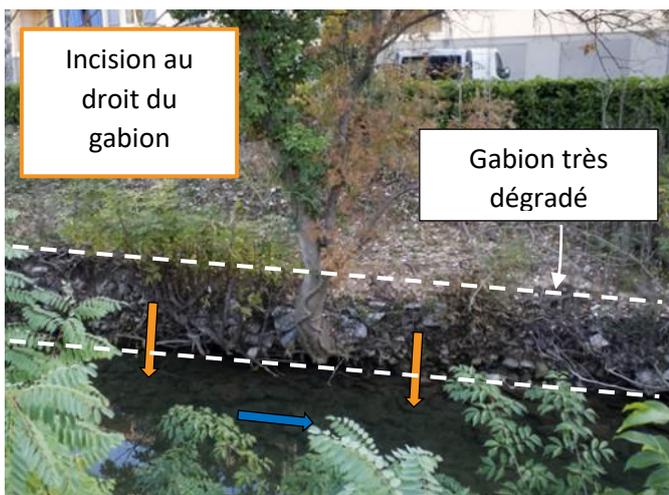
Photo du mur en gabion (rive gauche), en état de dégradation avancé, dans la traversée de Salernes
